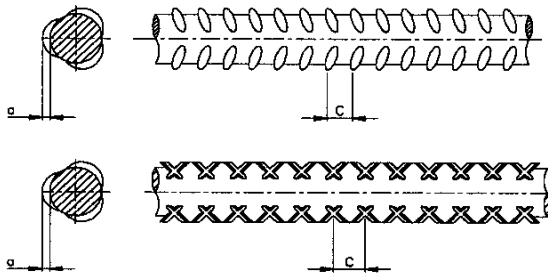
DETALLE DE ALTURA Y ESPACIAMIENTO DE LOS RESALTES
